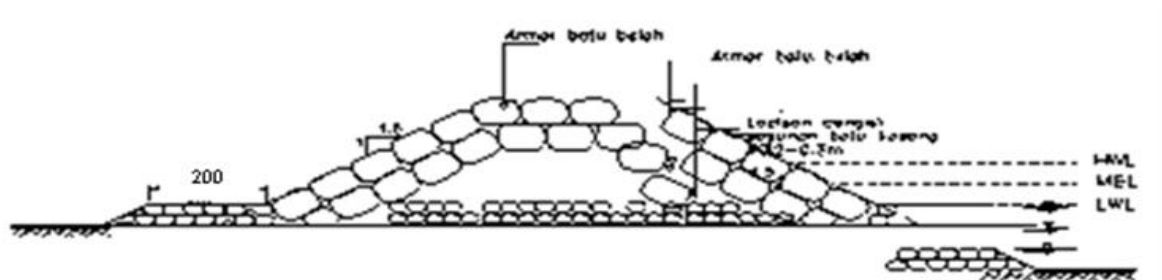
Sketsa potongan melintang struktur krib laut tipe *rubble mound
